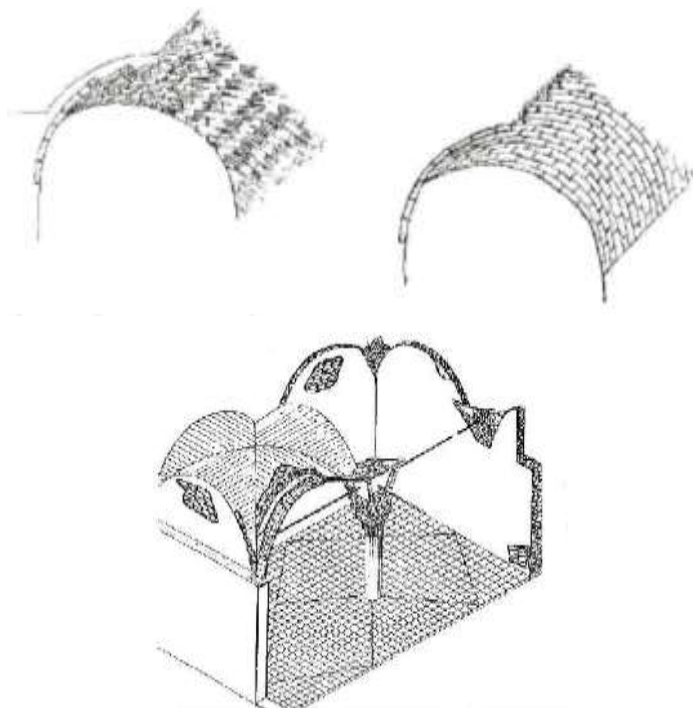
Technique constructive des voûtes en berceau en briques jointoyées en plâtre
